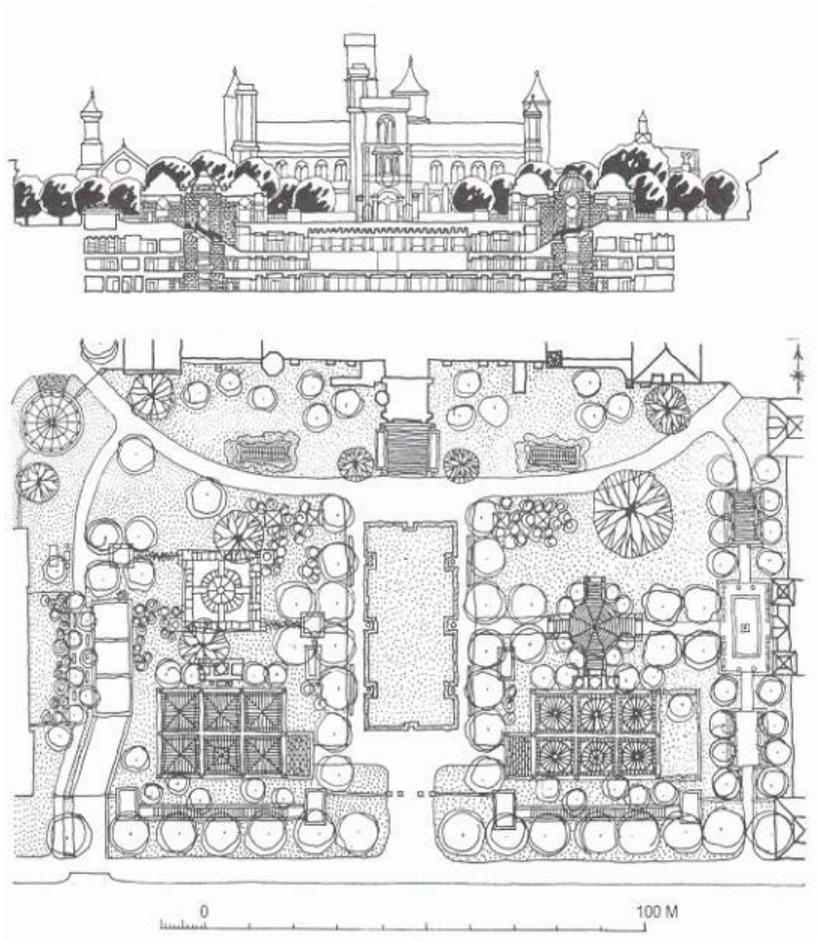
Сад на даху нового музею Східного мистецтва у дворі будівлі Смітсоніан (Вашингтон, 1987р.). Розріз по музею і план саду.
